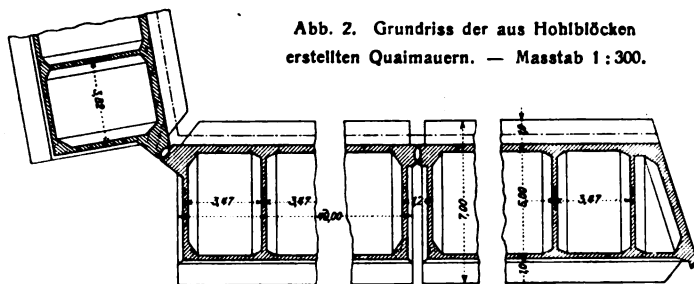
Grundriss der aus Hohlblöcken erstellten Quaimauern. — Masstab 1 : 300.
